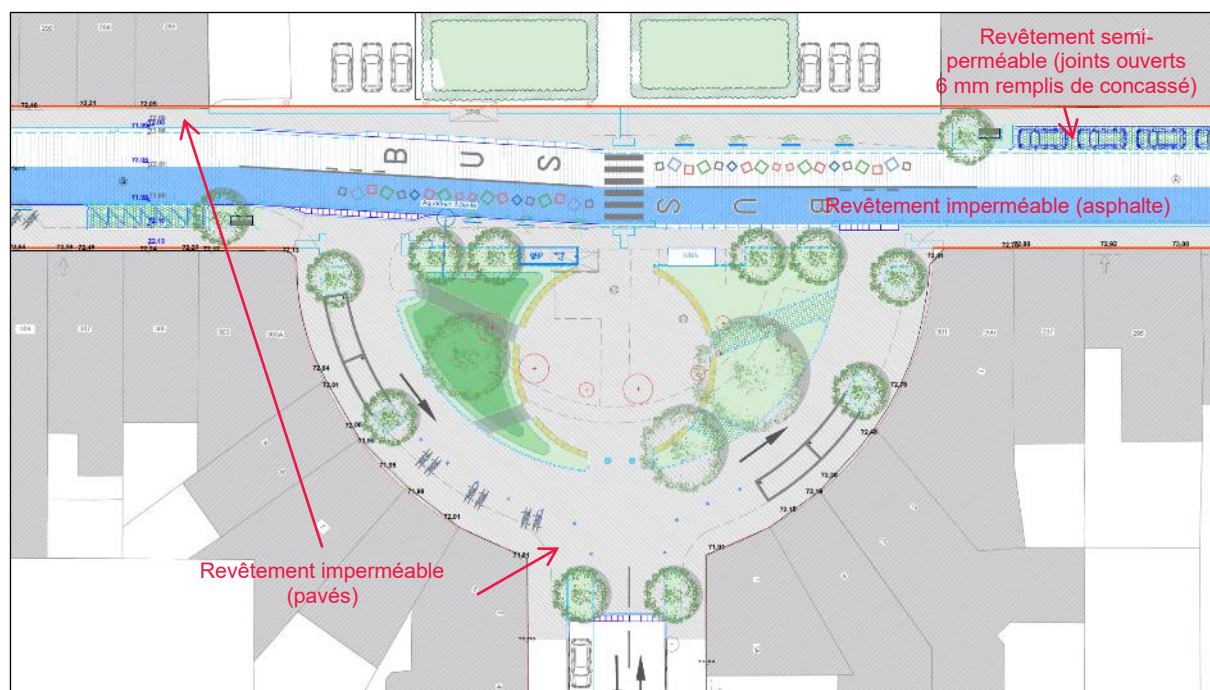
Zoom sur la place J.B. Degroof (source : Demandeur)
